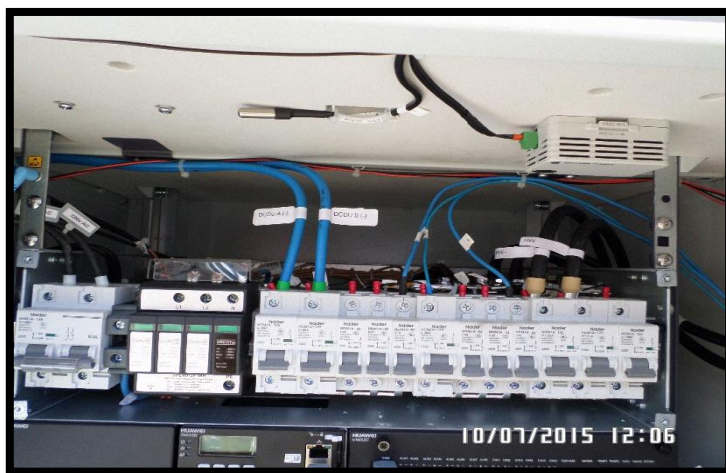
Distribución DC en el Site Santa Teresa
